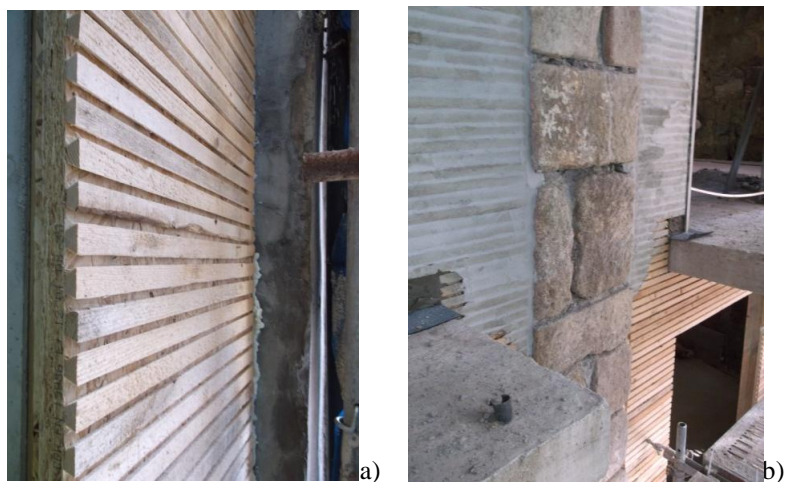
| Estrutura da parede de “tabique” com prumos verticais de madeira de pinho.
